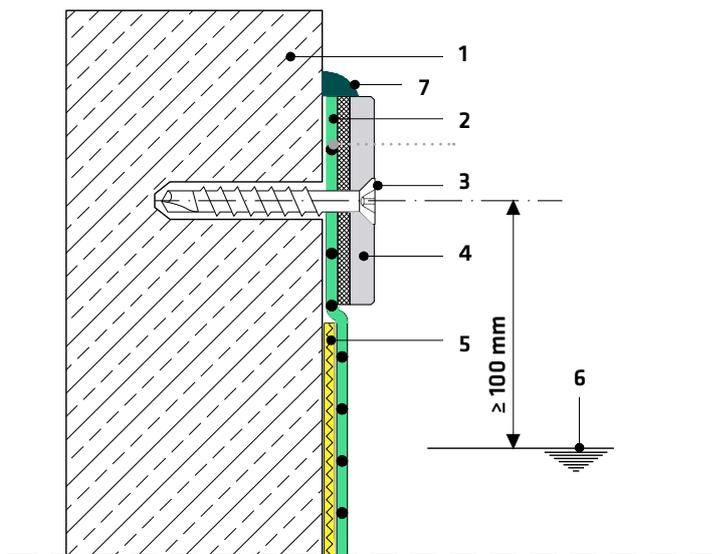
| Randabschluss auf Sikaplan® WP/WT Verbundblechwinkel
